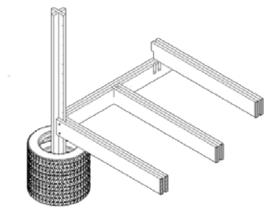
Cimentación y envigado FUENTE: Autoría propia.
